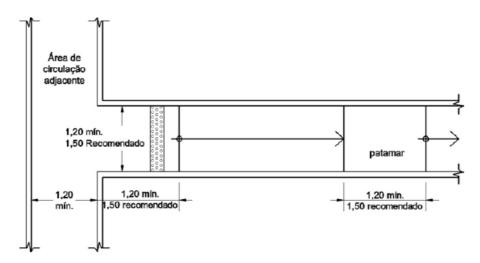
Seguimento de rampa com patamar (ABNT NBR 9050 ITEM 6.5.2.1)
